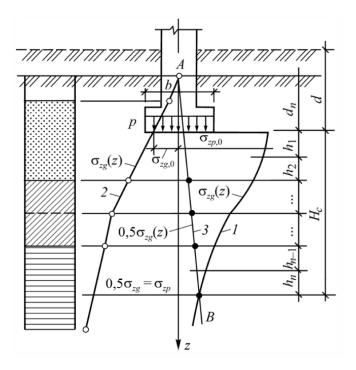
Схема к расчету осадки фундамента: I — эпюра давления от сооружения; 2 — эпюра бытового давления; 3 — линия 0,2 бытового давления
